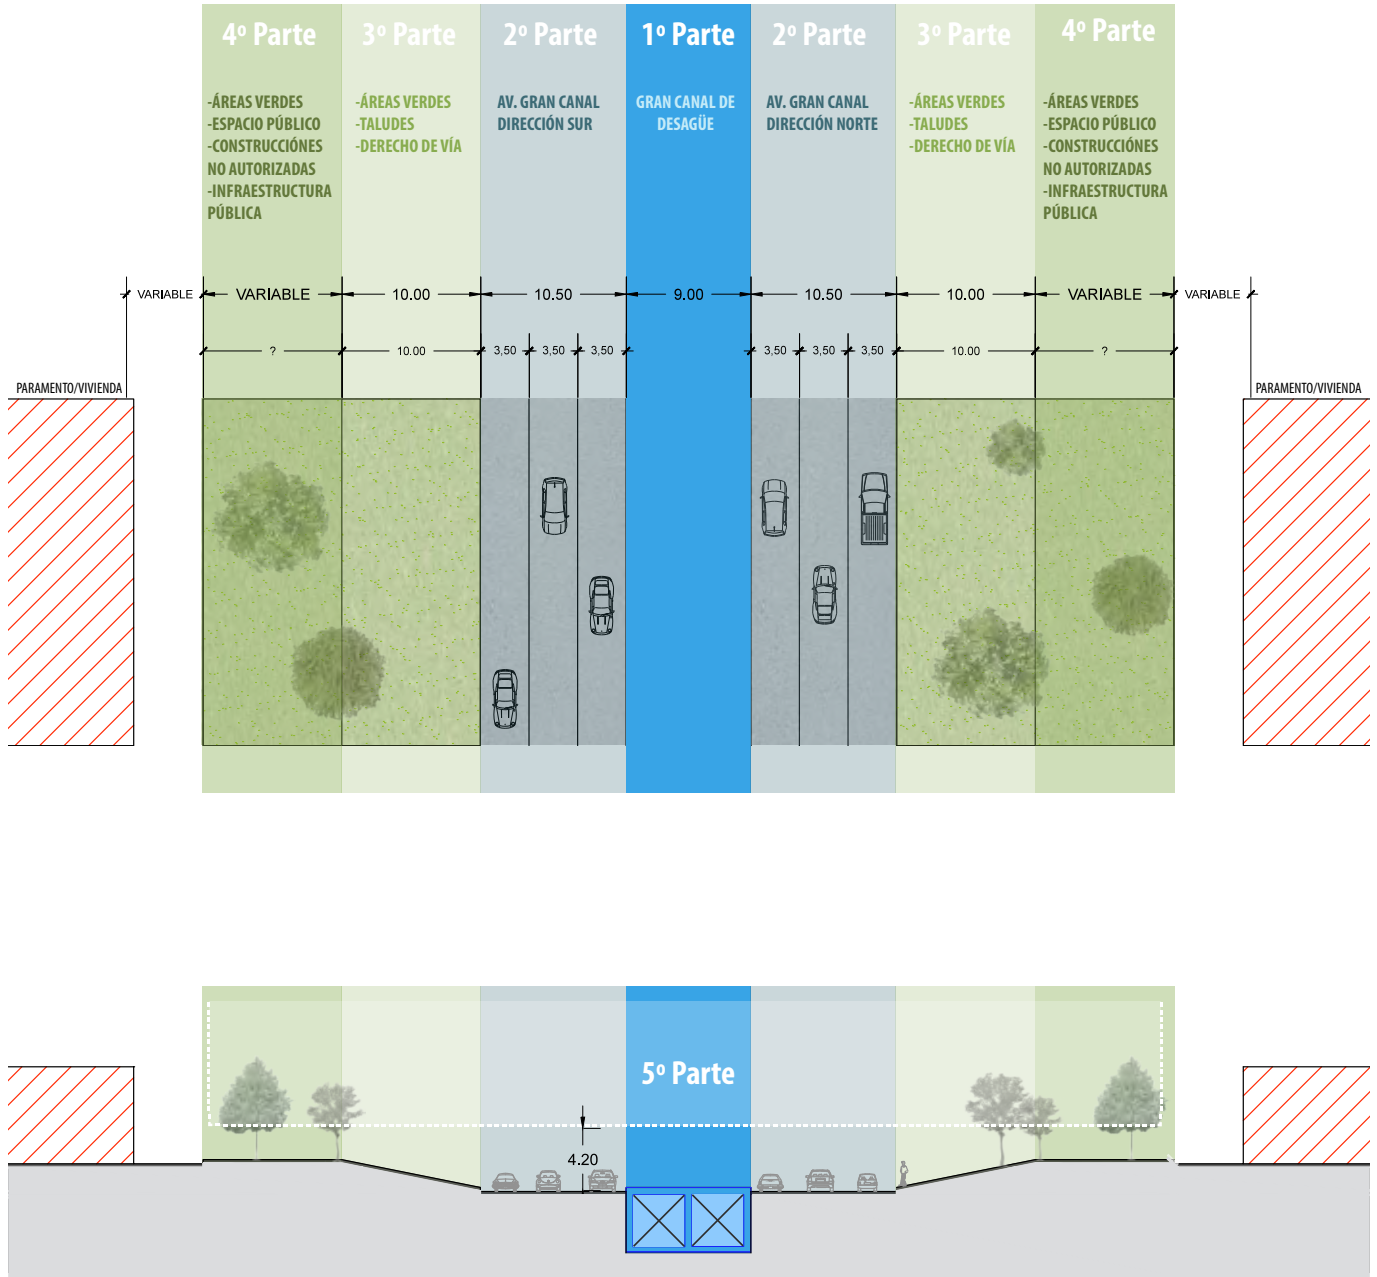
Planta y corte tipo del borde urbano Av. Gran Canal
